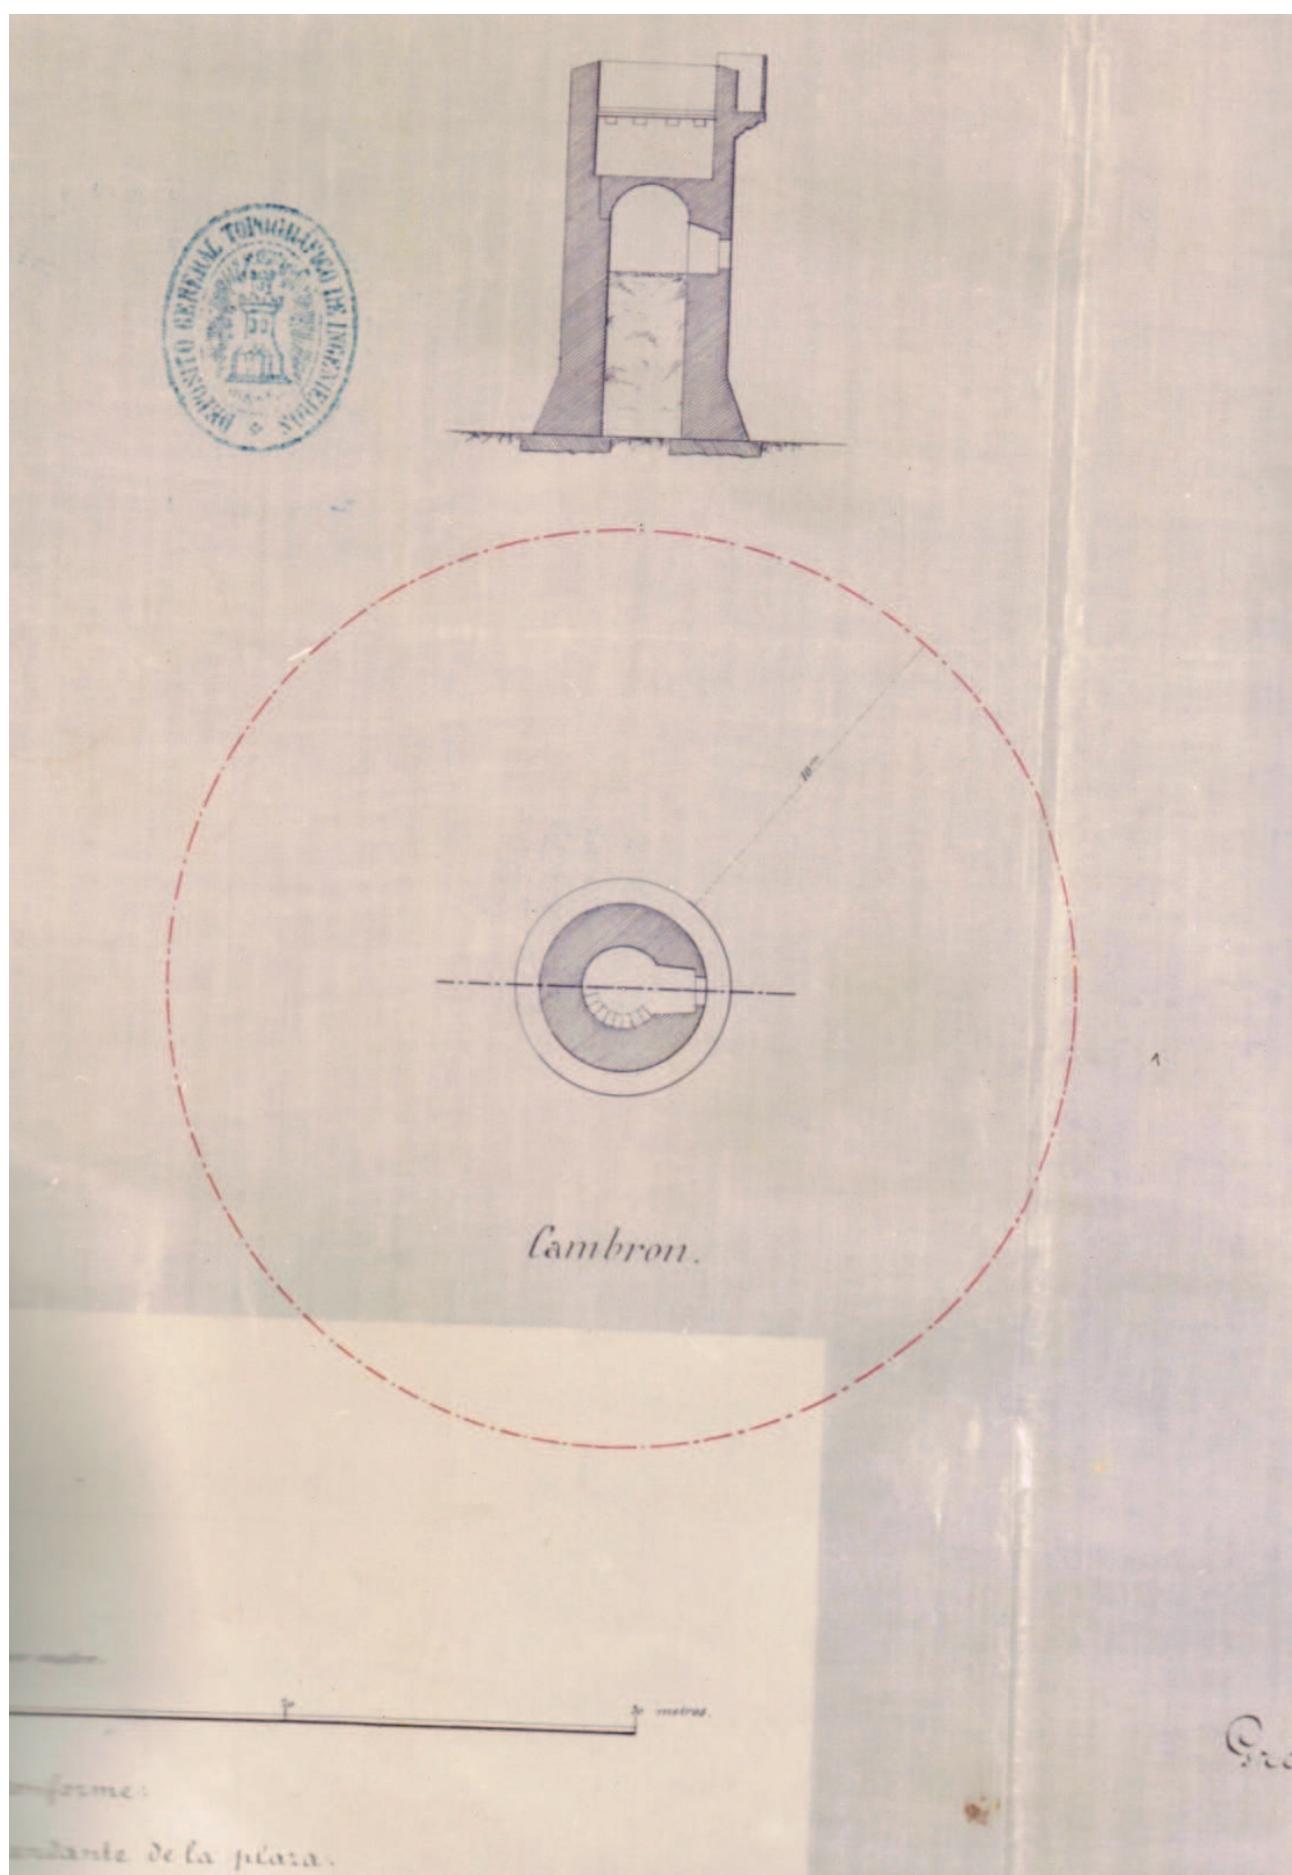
Planta y sección de la Torre del Cambrón. Documento de 1868. Archivo del Servicio Histórico del Ejército (A.S.H.E.)
